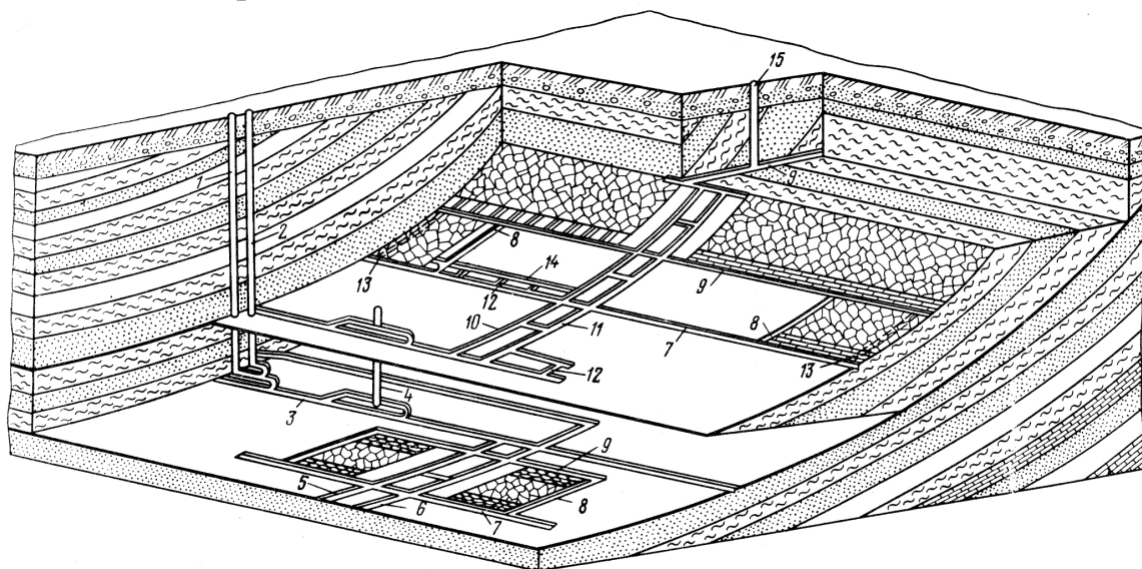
Схема расположения горных выработок: 1,2 – шахтные вертикальные стволы; 3 – главный транспортный штрек; 4 – гезенк; 5 – уклон; 6 – ходок при уклоне; 7 – транспортные штреки; 8 – лавы; 9 – вентиляционные штреки; 10 – ходок при бремсберге; 11 – бремсберг, 12 – сбойка; 13 – разрезные печи (монтажные камеры); 14 – просек; 15 – шурф
